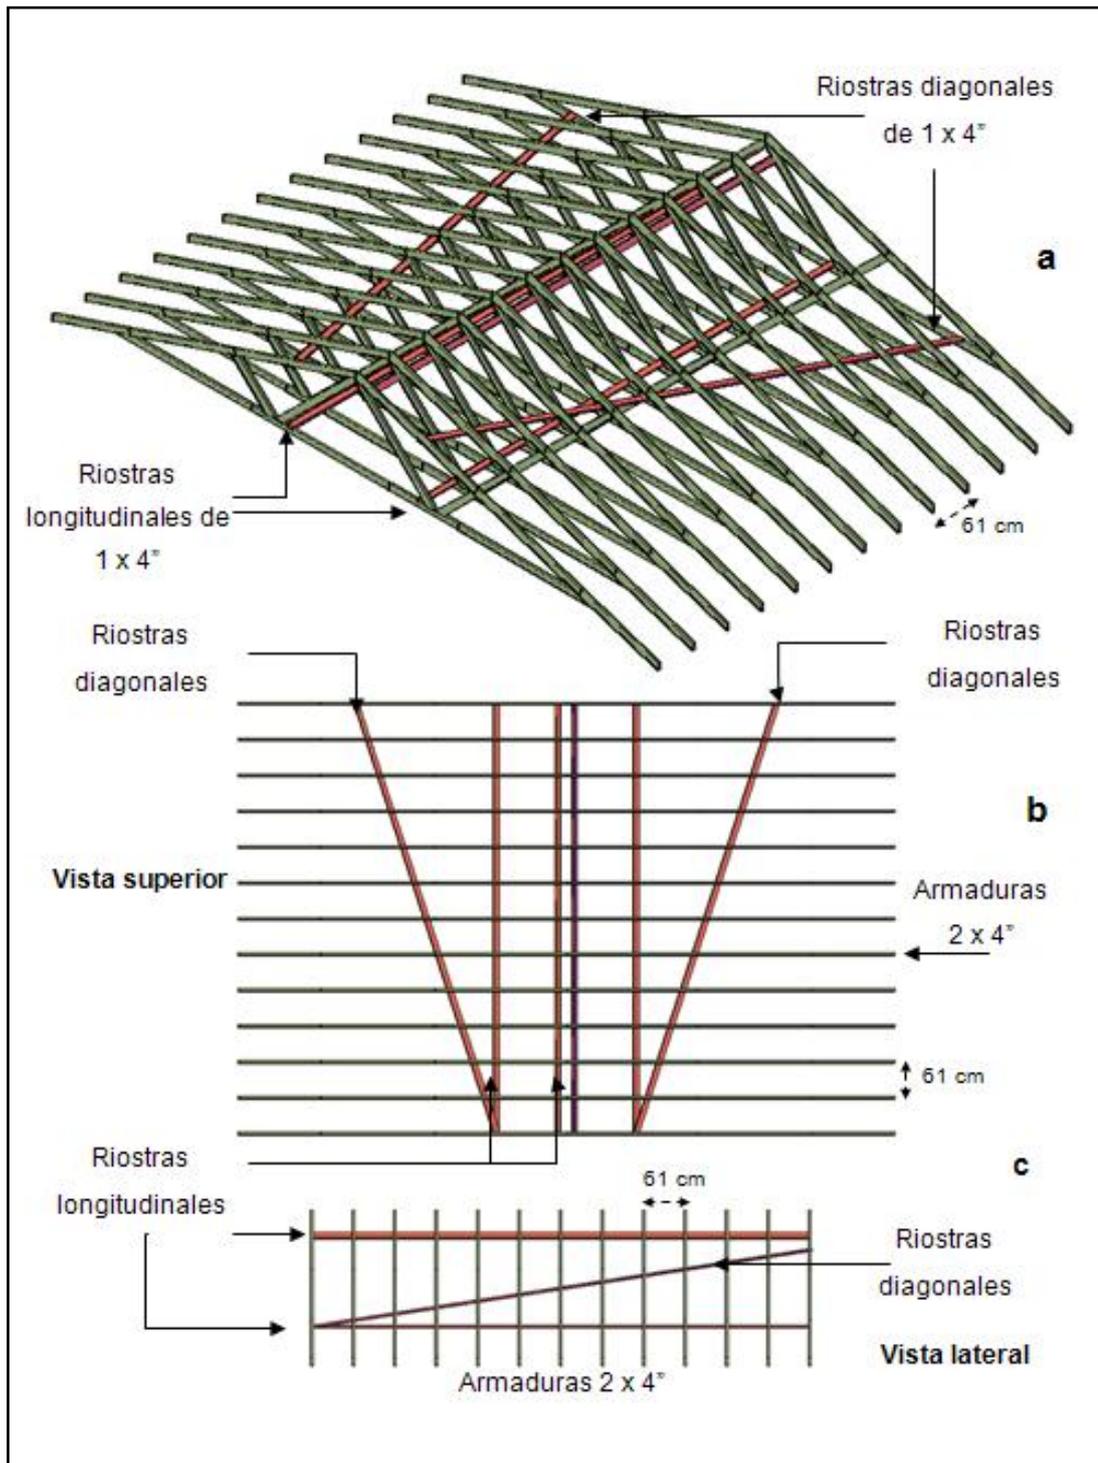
Colocación de las riostras durante el armado de las armaduras: a) Vista en isométrico; b) Vista superior; d) Vista lateral.
